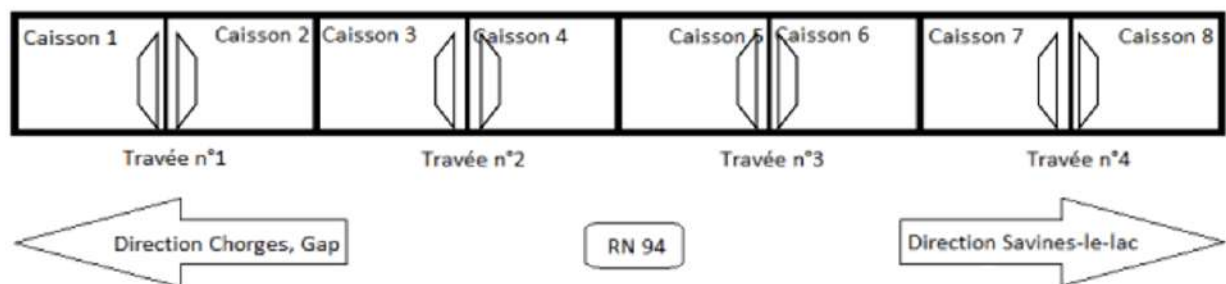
Schématisation du plan du pont de Riou-Bourdou.
